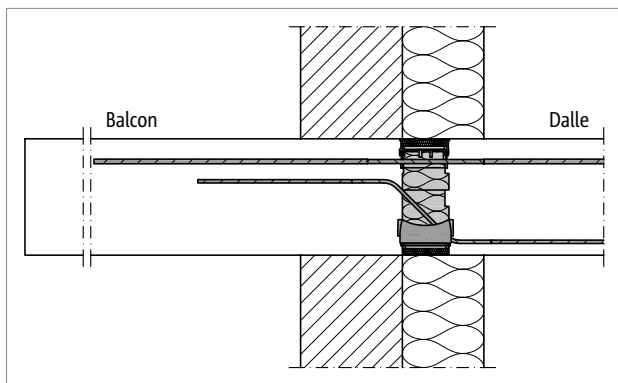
Schöck Rutherma® T type DBi : liaison pour balcon en béton dans le cas d'une façade en maçonnerie et dalle en béton coulé sur place
